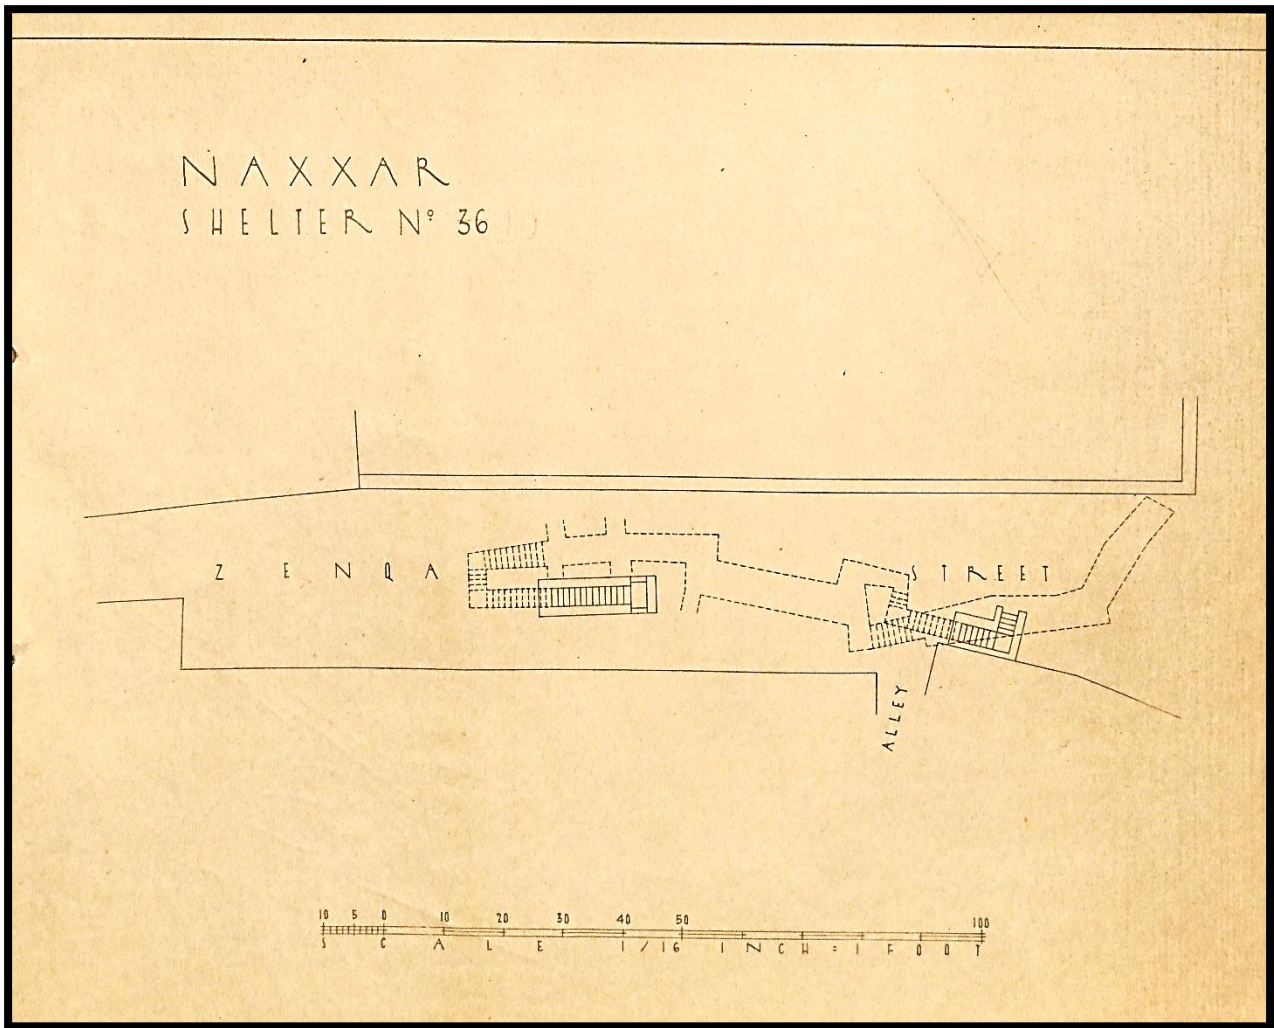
Planta do Abrigo nº36 "Zenqa Street – Alley"
